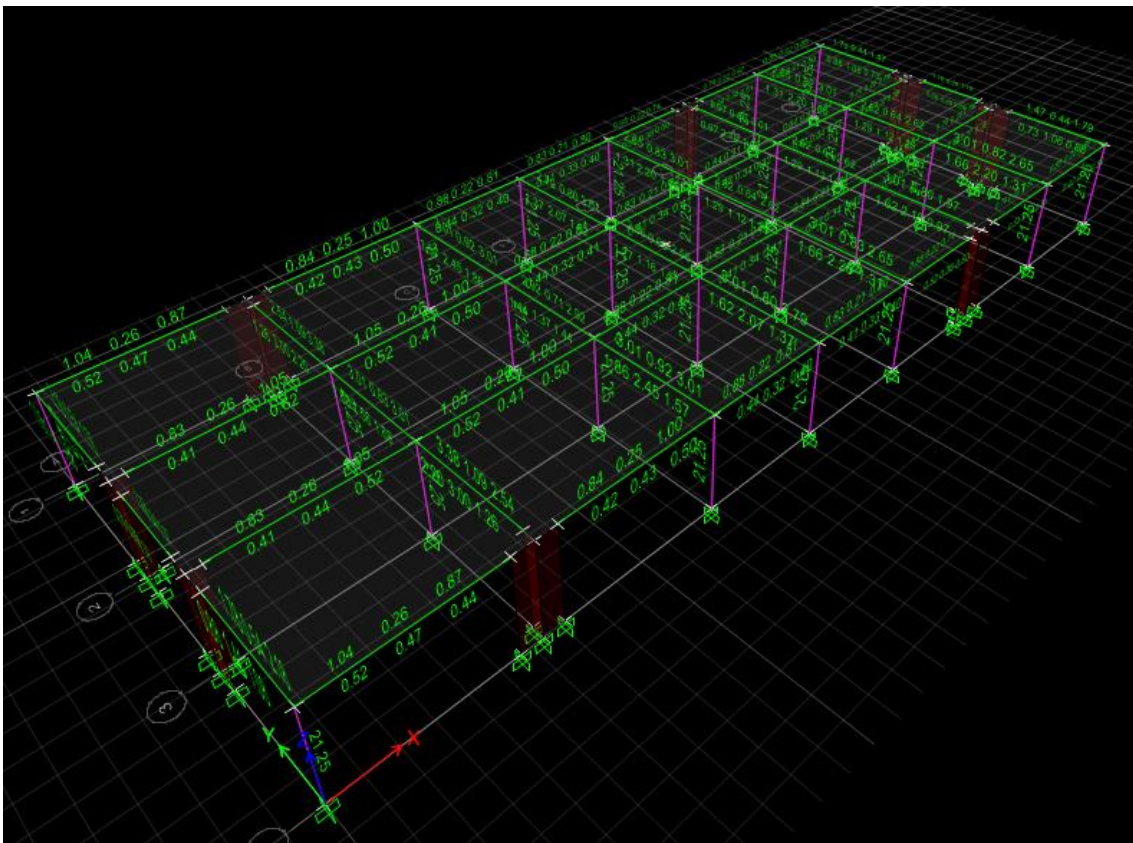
Acero requerido para los elementos estructurales del módulo 03
